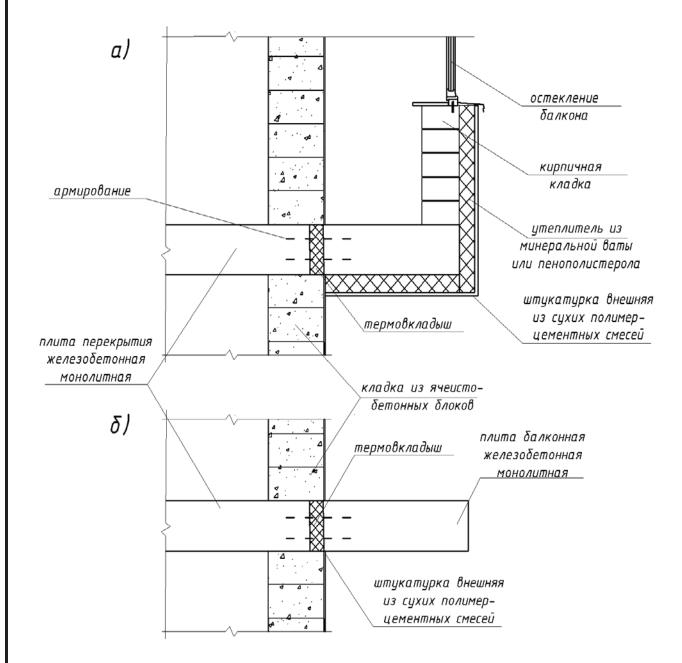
а) утепление балкона (остекленного) с внешней стороны плитным утеплителем. б) конструктивно-теплотехническое решение узла примыкания балконной плиты к плите перекрытия путем устройства термовкладышей по всей длине балконной плиты.
